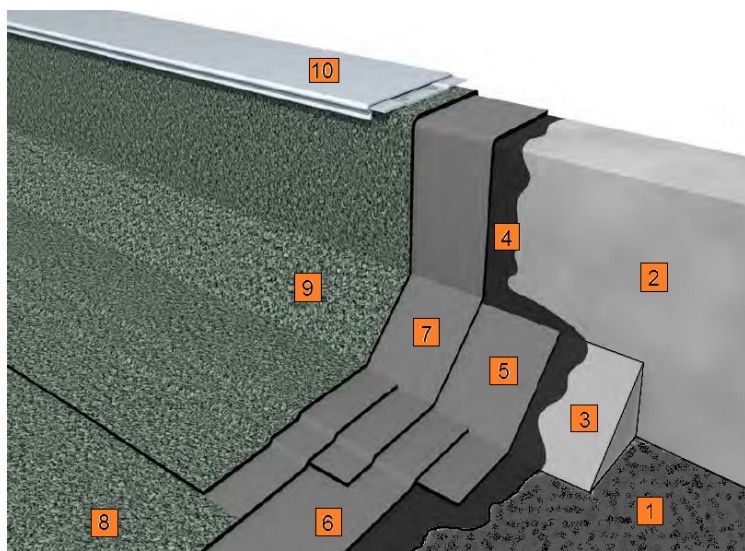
Основные слои кровельной конструкции в месте примыкания к парапету:
